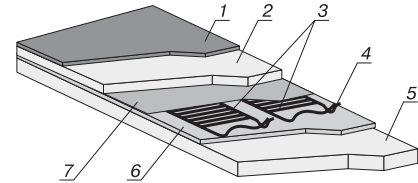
1 – покрытие пола; 2 – бесшовный пол (например, бетонный); 3 – нагреватель пленочный; 4 – питающий кабель; 5 – бетонная плита; 6 – теплоизоляционный материал; 7 – накрывающая пленка.
